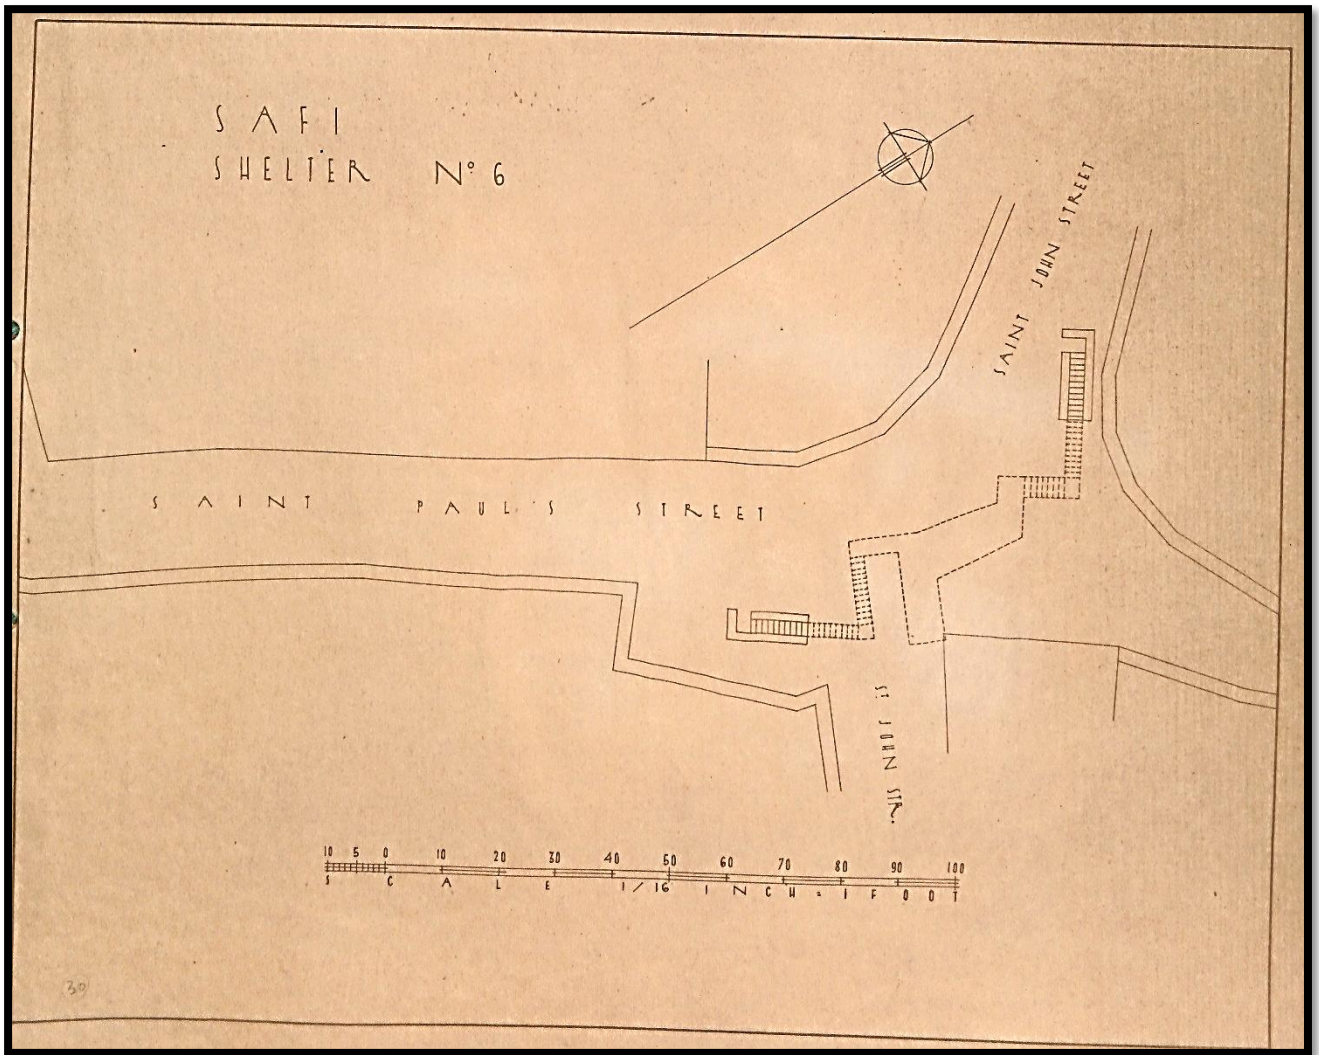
Planta do Abrigo nº6 "Saint Paul's Street – Saint John Street."
